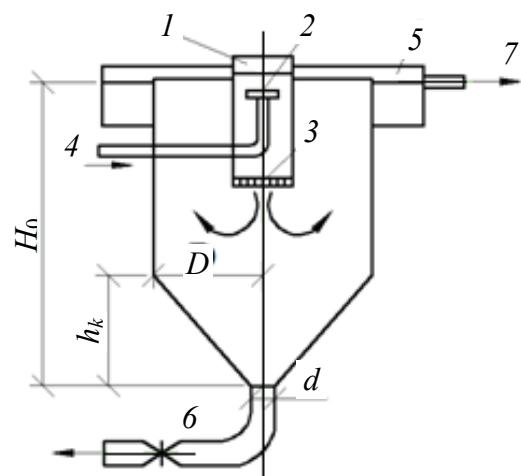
Вертикальный отстойник: 1 – камера хлопьеобразования; 2 – сегнетово колесо с насадками; 3 – гаситель; 4 – подача исходной воды (из смесителя); 5 – сборный желоб вертикального отстойника; 6 – труба для отвода осадка из вертикального отстойника; 7 – отвод воды из отстойника
